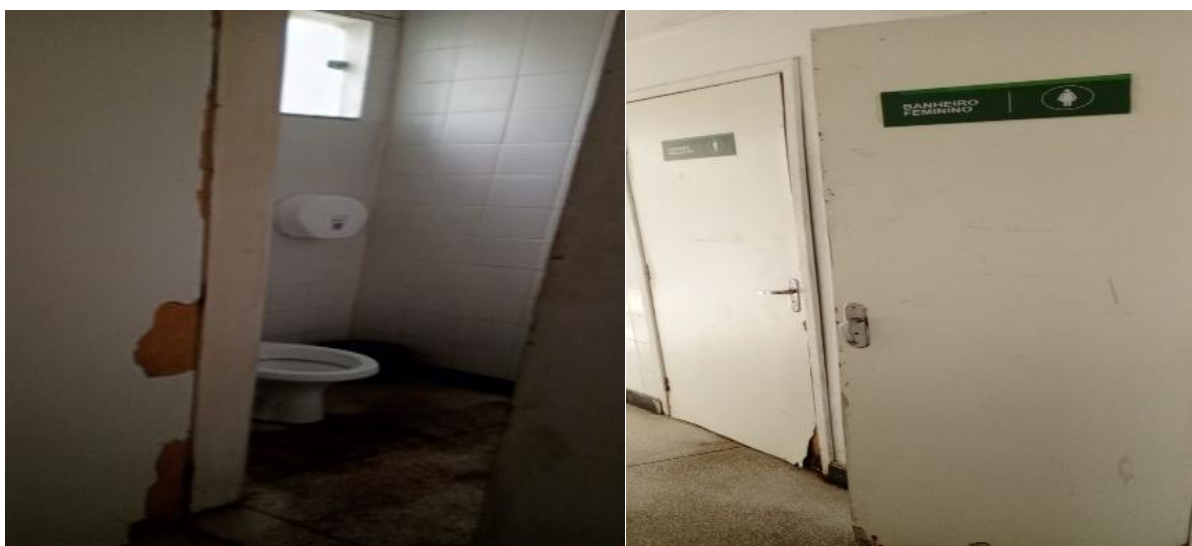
Banheiros em mau estado de conservação - Sooretama
